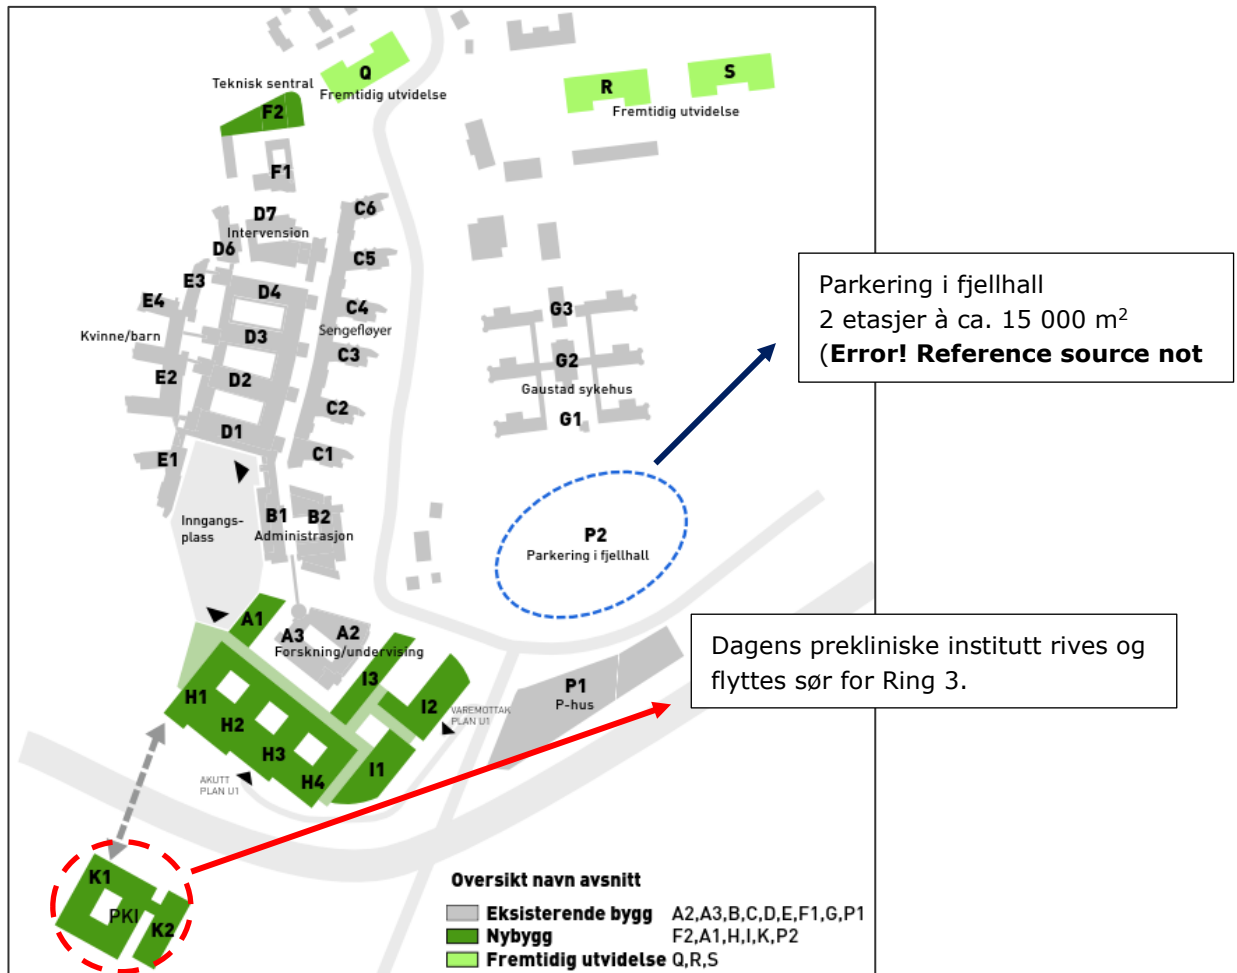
Landskapsplan med plassering av fjellhall. Planalternativ 2A. (Prosjekteringsgruppen, 2019).
